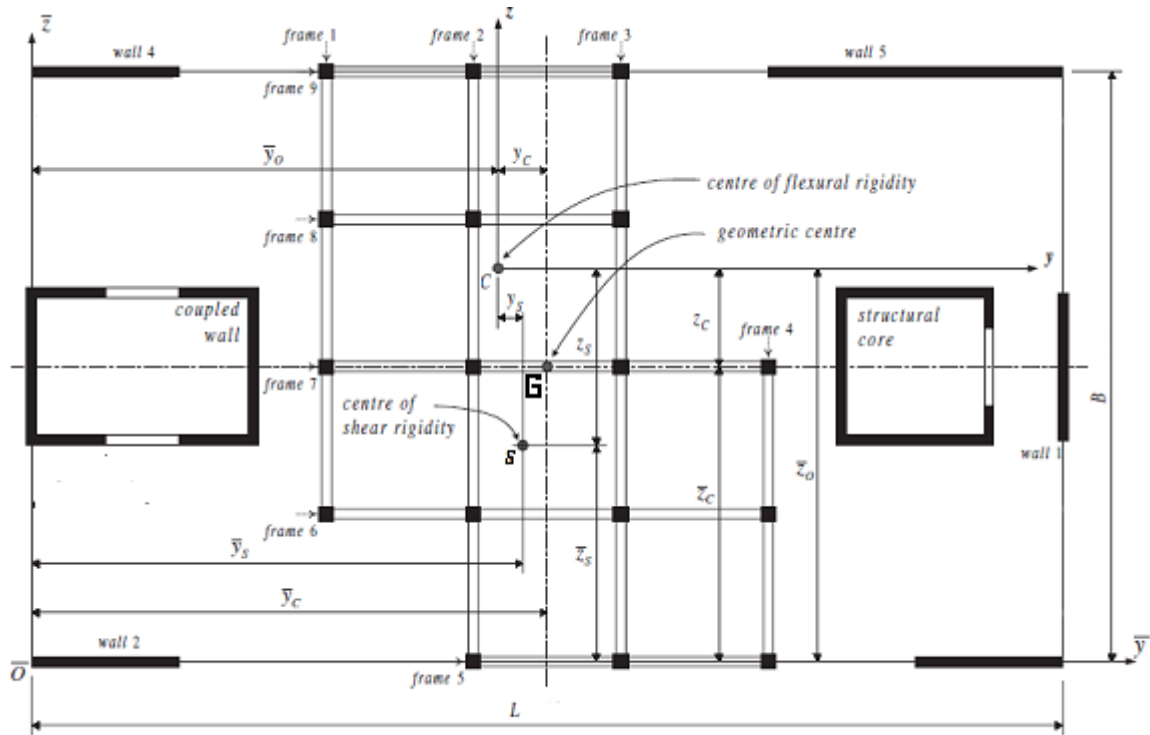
Plan du plancher de structure en murs voiles asymétrique [64].
